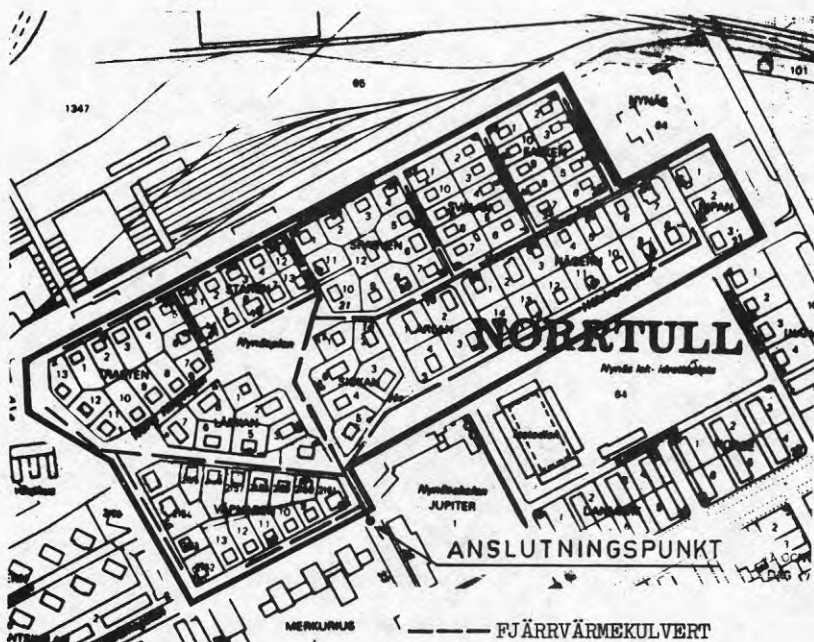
PLANERAT KULVERTNÄT VID FJÄRRVÄRME
